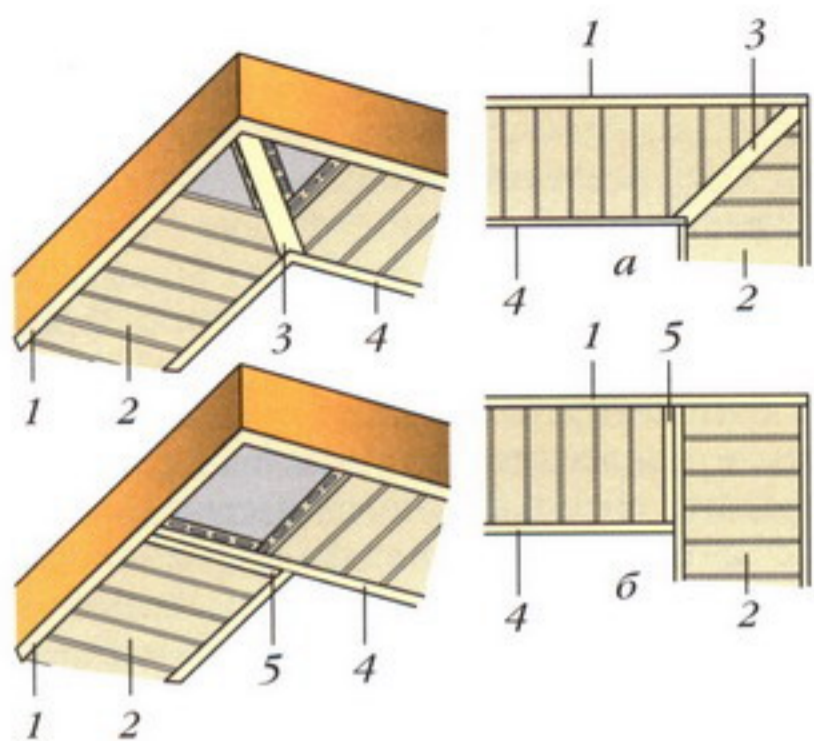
Соединение софитных подшивок на углах: а — на косой угол; б — на прямой угол; 1 — карнизный принимающий профиль; 2 — софит; 3 — Н-профиль или два J-профиля; 4 — пристенный принимающий профиль; 5 — J-профиль
